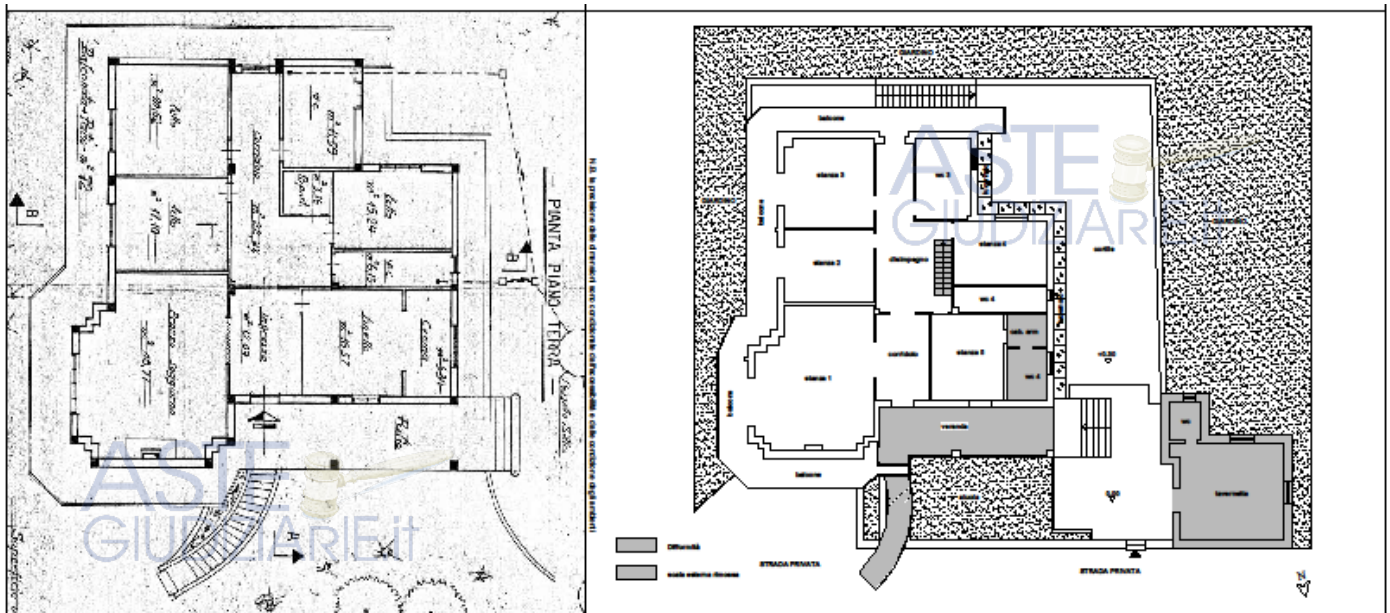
Confronto tra lo stato dei luoghi Piano Terra e planimetria allegata all'istanza di sanatoria edilizia
